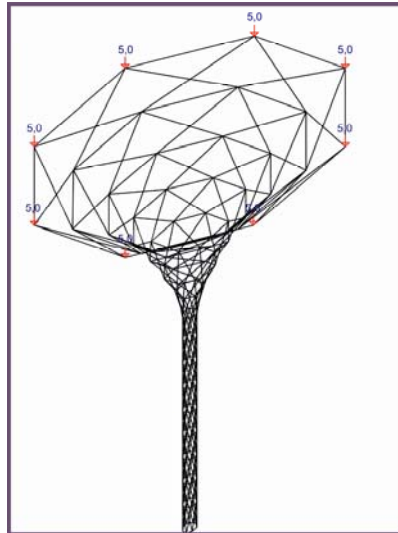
Схема распределения нагрузок на узлы верхнего пояса колонны
